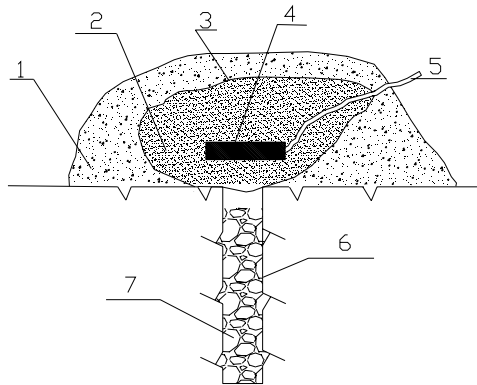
混凝土浇筑层面渗压计埋设安装示意图
